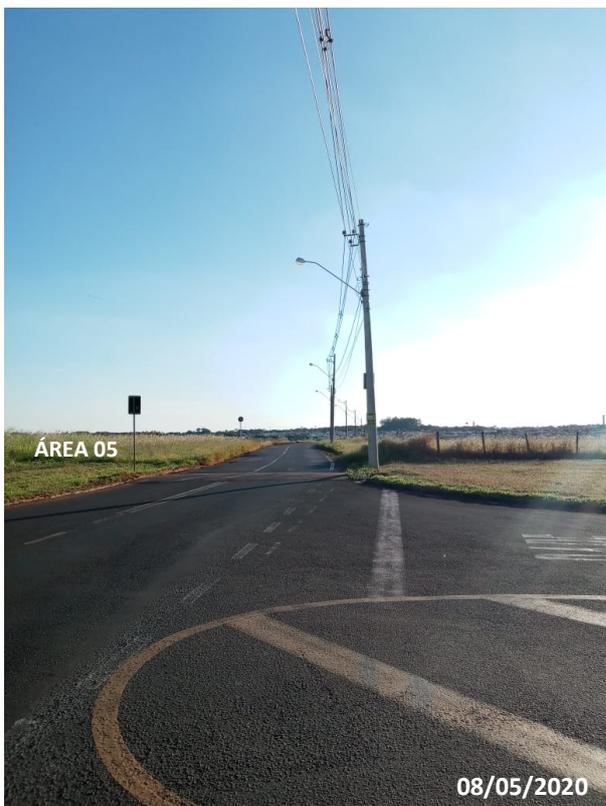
Boas condições de conservação da sinalização e da pavimentação das vias e acesso.
